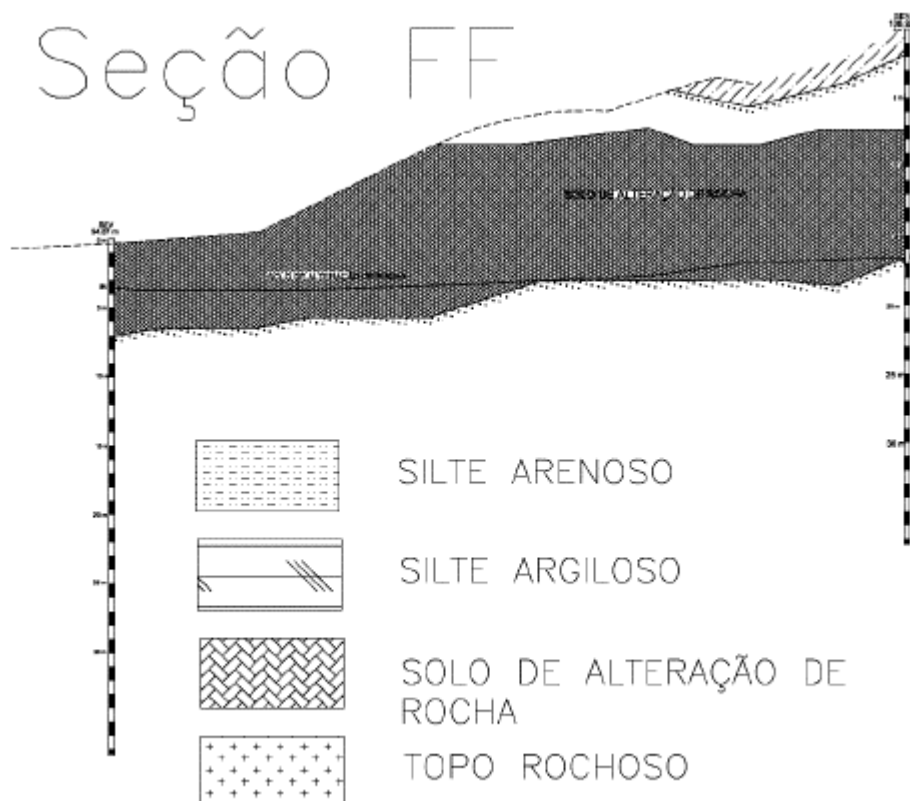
Perfil Geotécnico definido pelas Sondagens Mistas – Seção “FF”.
